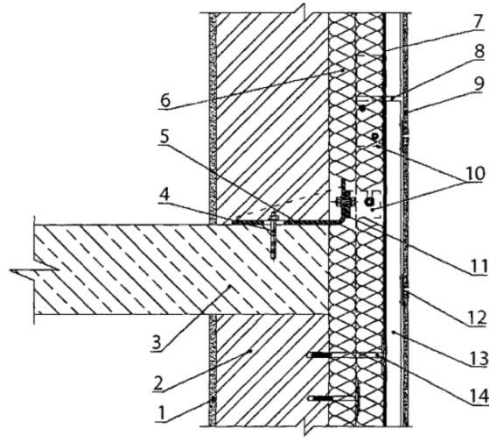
Конструктивне вирішення кріплення опоряджувального шару каркасних систем. 1 - внутрішня штукатурка; 2 - несуча частина стіни; 3 - залізобетонна плита перекриття; 4 - анкер клиновий; 5 - кронштейн; 6 - шар теплової ізоляції; 7 - повітрозахисна мембранна плівка; 8 - повітряний вентиляований прошарок; 9 - індустріальні личкувальні елементи (керамічні плити); 10 - з'єднувальні елементи; 11 – прокладка; 12 - клямер; 13 - стояк; 14 - елемент механічного кріплення утеплювач
